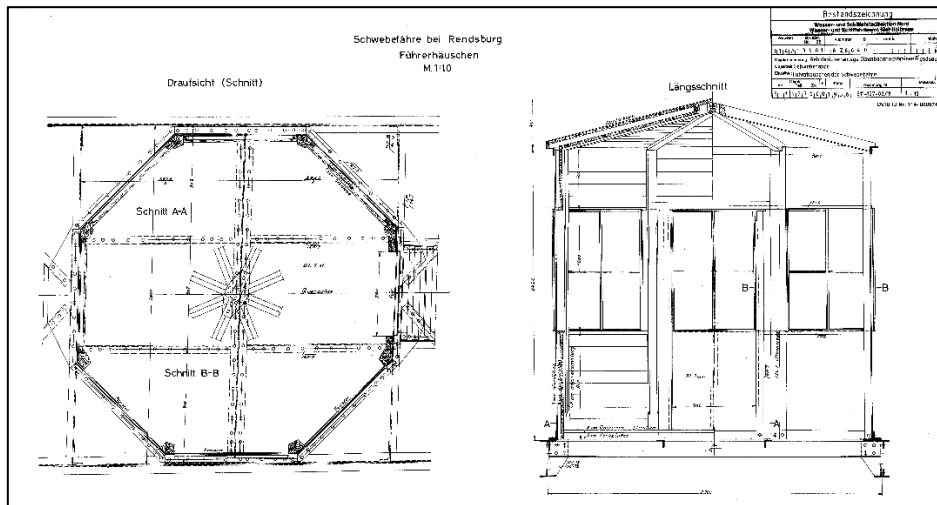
Grundriss des Führerhauses der Schwebefähre
